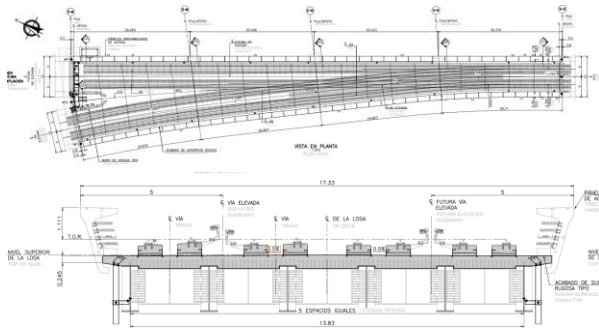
Planta y sección del viaducto para futura ampliación: Tablero mixto – vigas doble T.
